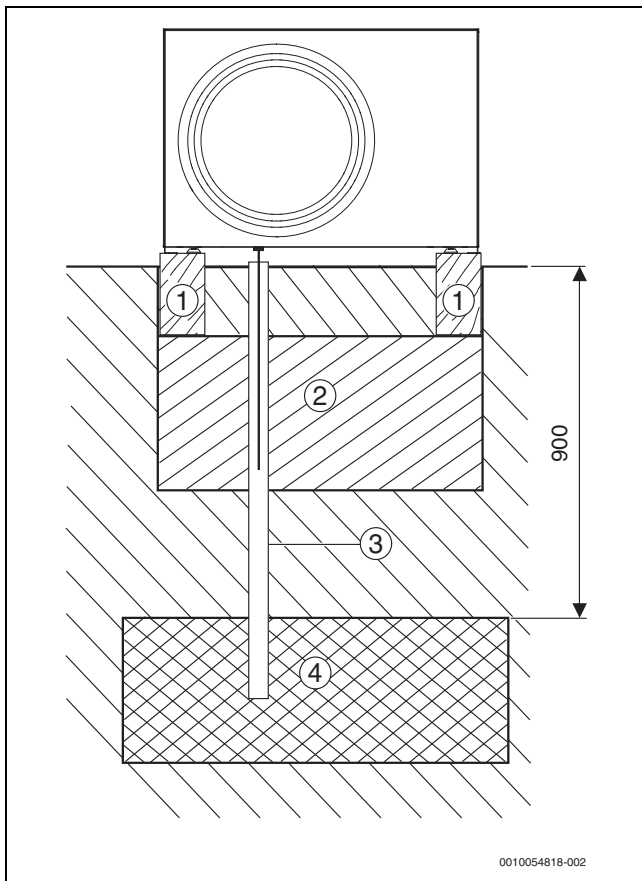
Scarico della condensa nel letto di ghiaia (dimensioni in mm)
